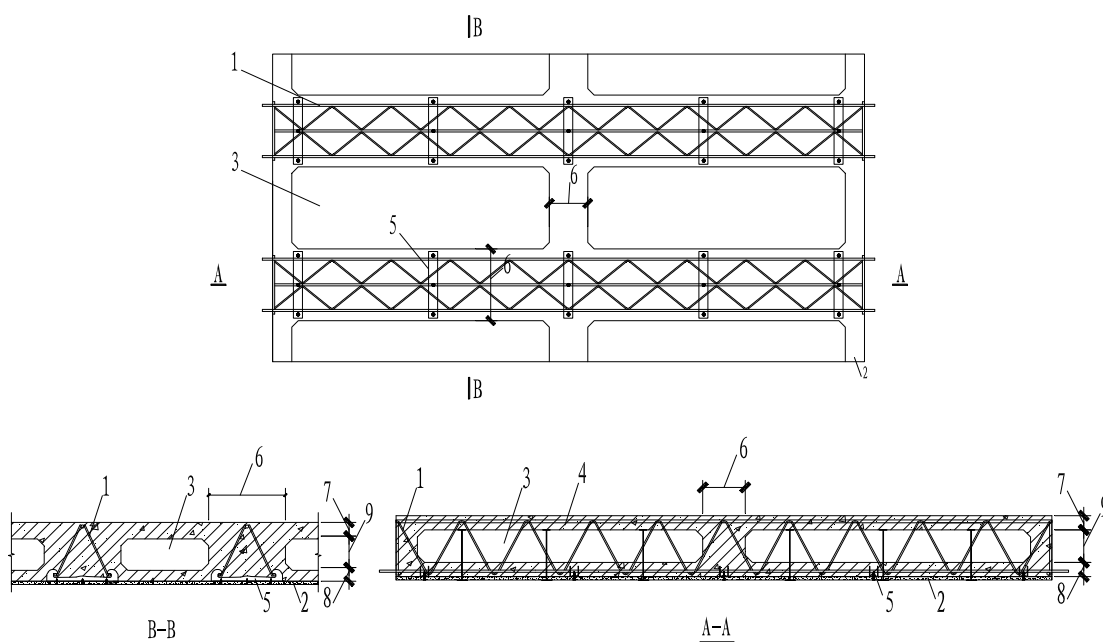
钢格栅轻质底板叠合空心板构造示意图
